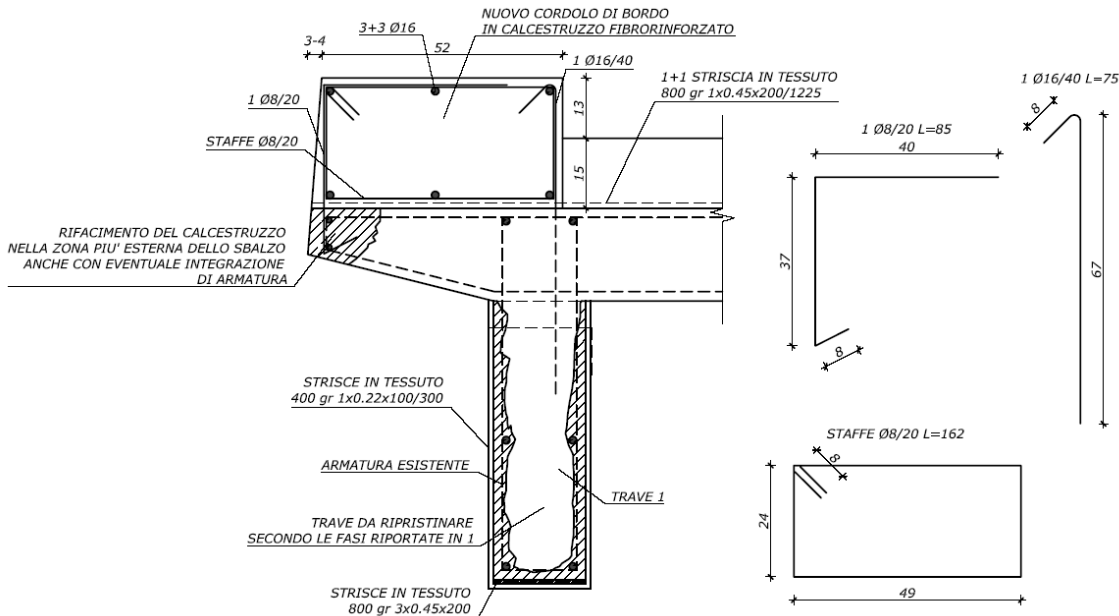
Dettaglio dell'intervento sulla trave esterna deteriorata
